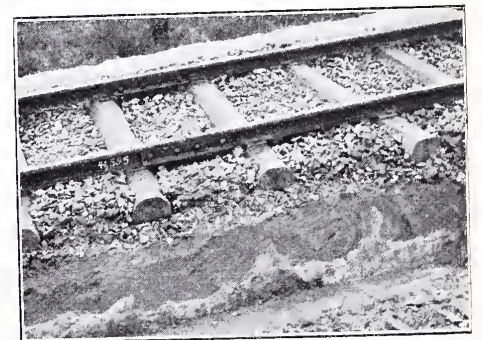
Bettung aus Basaltkleinschlag nach halbjährigem Betriebe.
